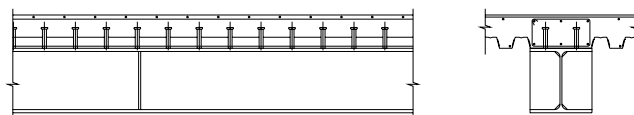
Jácenas mixtas del forjado en Planta Sótano Primero
